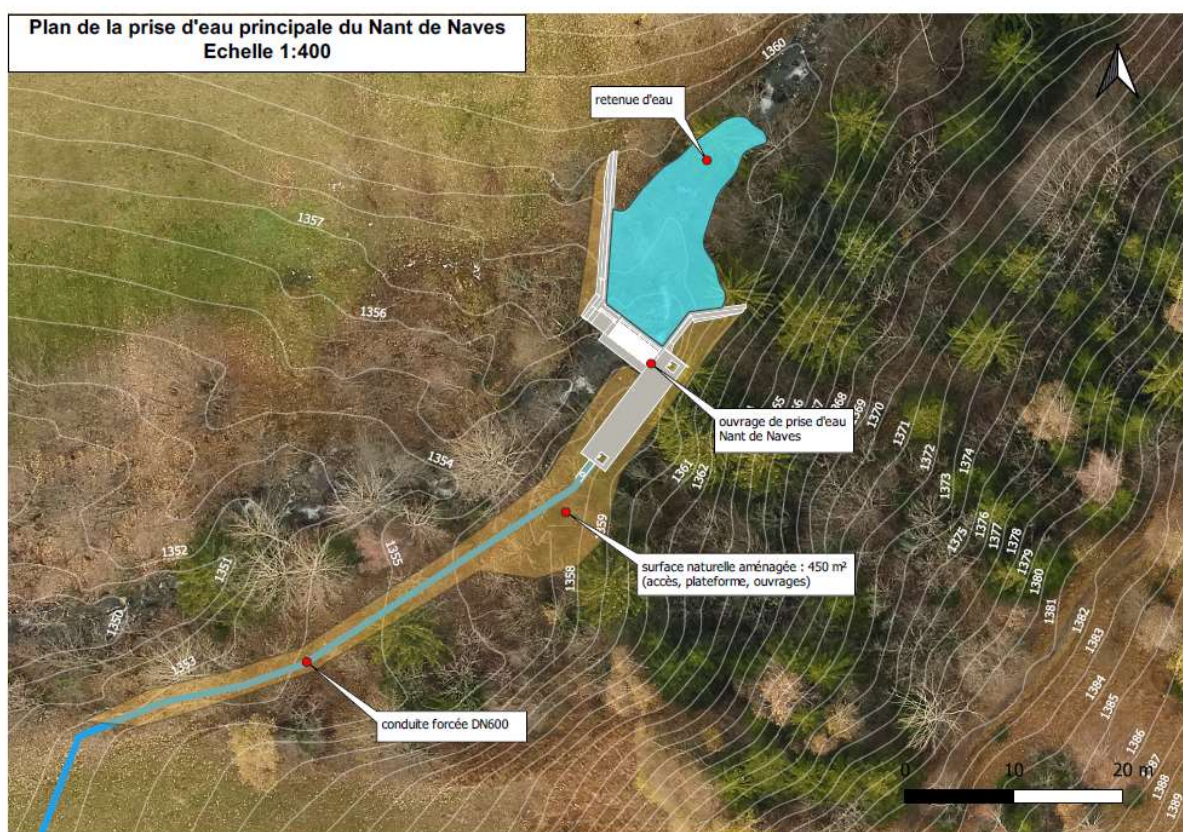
plan de masse au 1 :400 de la prise d'eau principale
